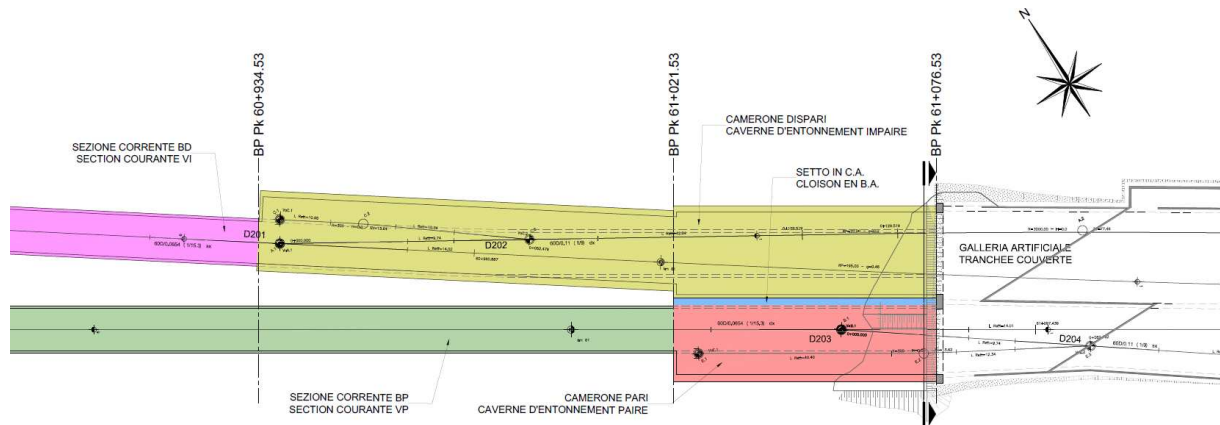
Planimetria delle sezioni allargate all'imbocco Est del Tunnel di Base (PRV_C3A_7617_33-02-02)
